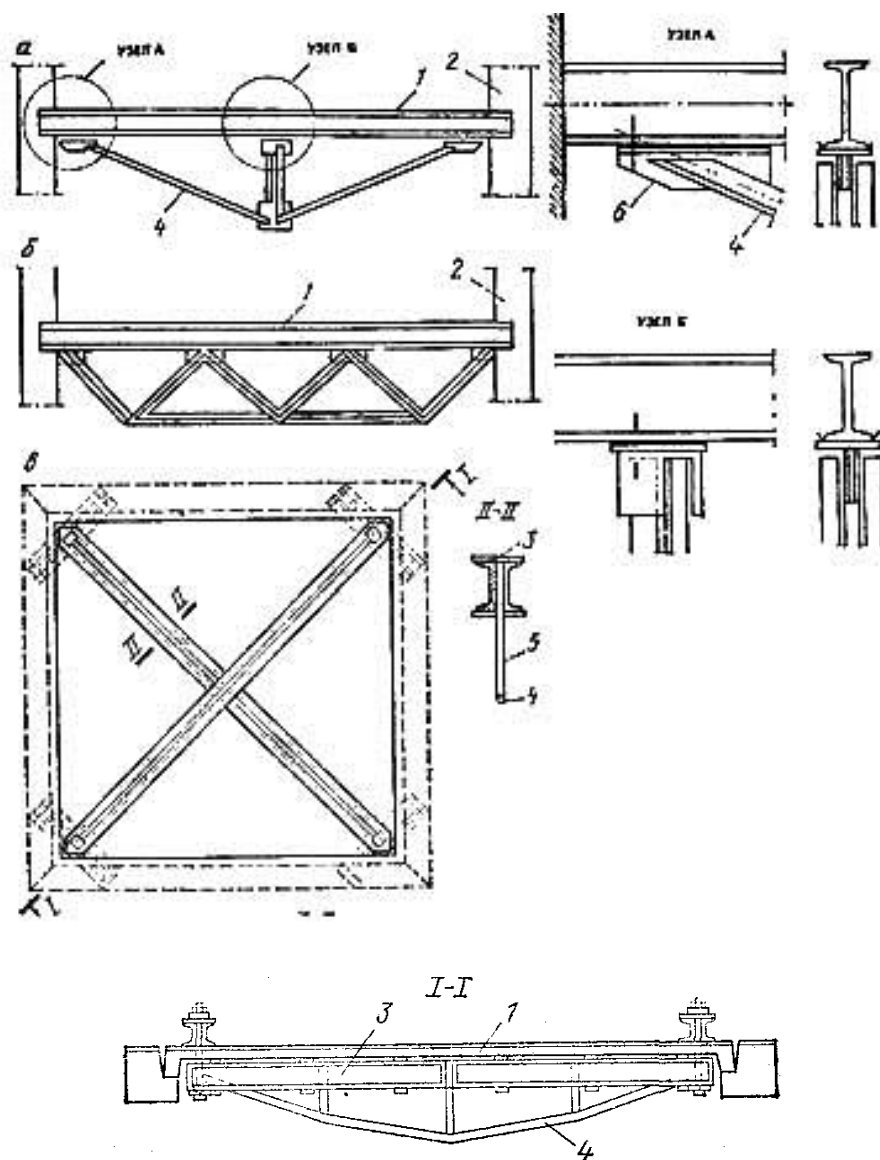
Усиление конструкций перекрытий шпренгелем а, б – варианты усиления стальной балки; в – усиление железобетонной плиты, опёртой по контуру; 1 – существующая конструкция перекрытий; 2 – существующая конструкция стен; 3 – верхний пояс; 4 – нижний пояс; 5 – стойка; 6 – анкер
